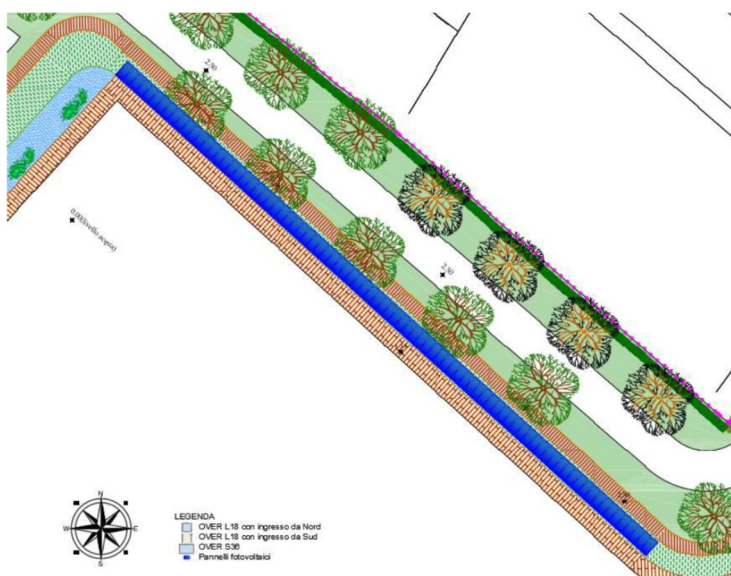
Planimetria di dettaglio impianto sponda interna darsena, avente potenza pari a 45,78 kWp
